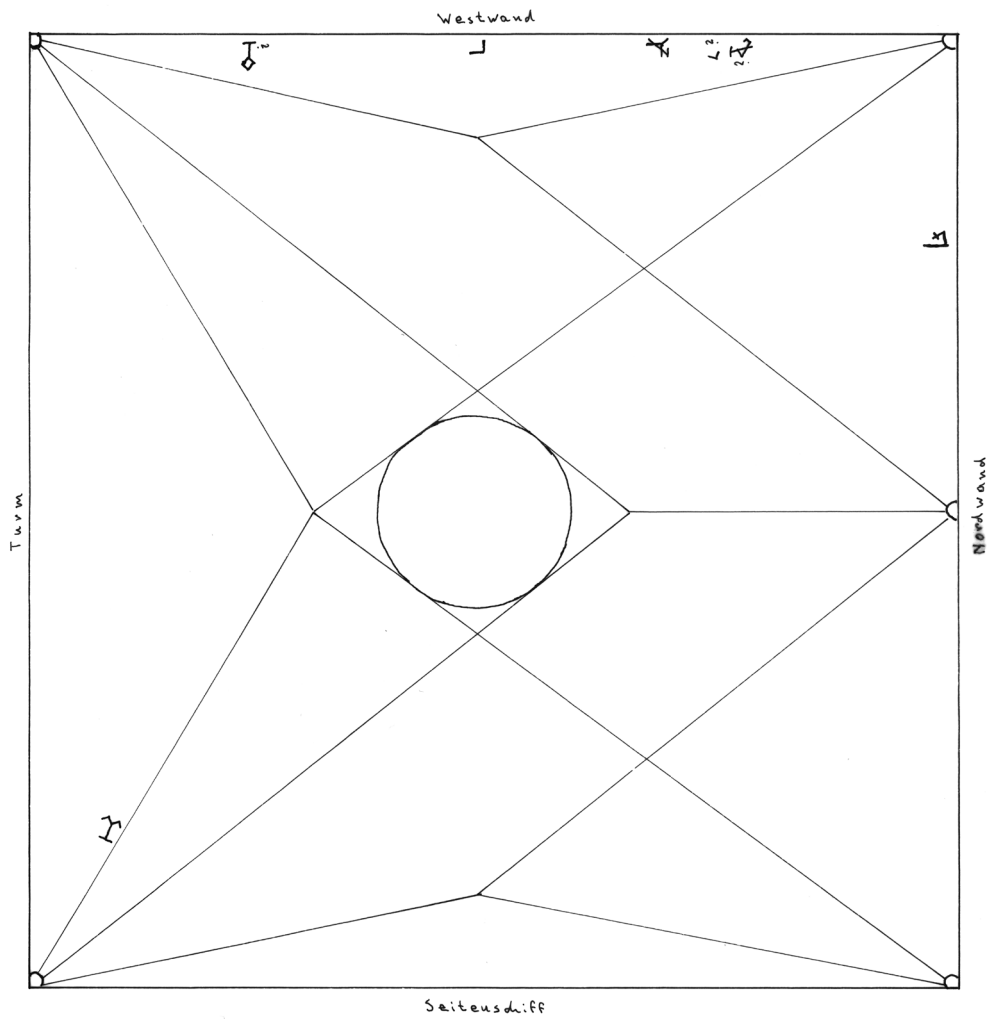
Verortung der nummerierten Planzeichnungen der Seitenschiffwestvorhallen im Grundriss
